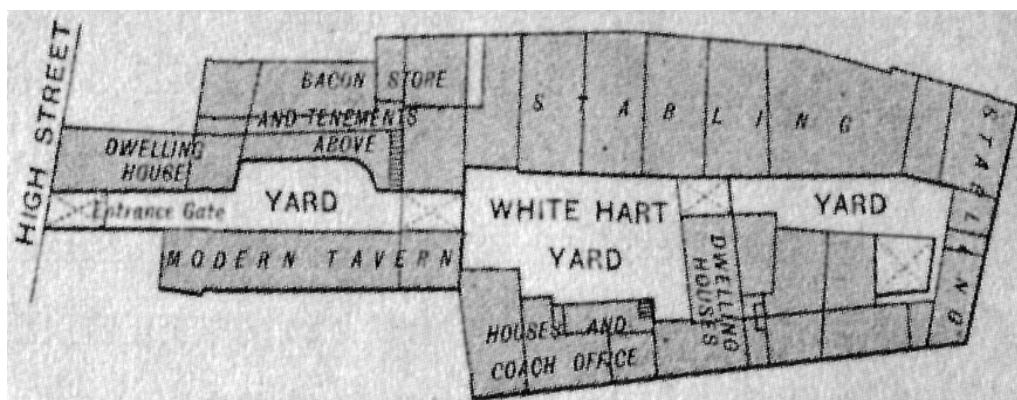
Planta do Inn Yard White Hart em Southwark
